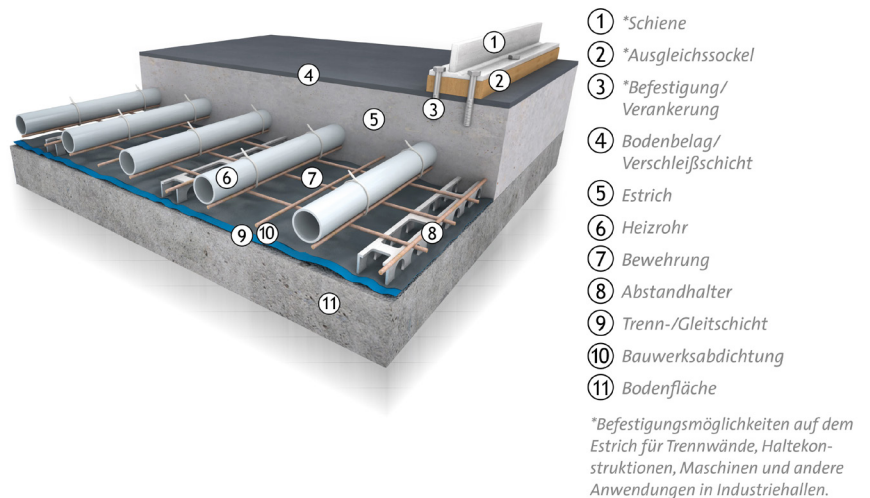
Schnittdarstellung einer typischen Fußbodenkonstruktion in einer Industriehalle.
